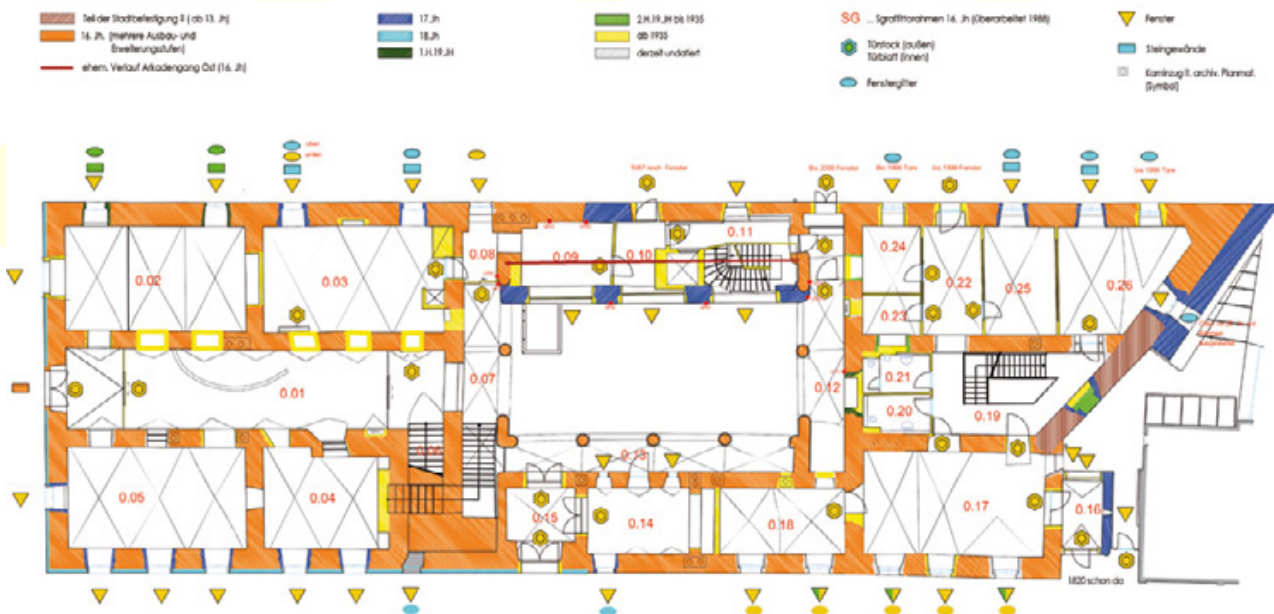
Klagenfurt, ehemaliges Salzamt. Baualterplan des Erdgeschosses.
